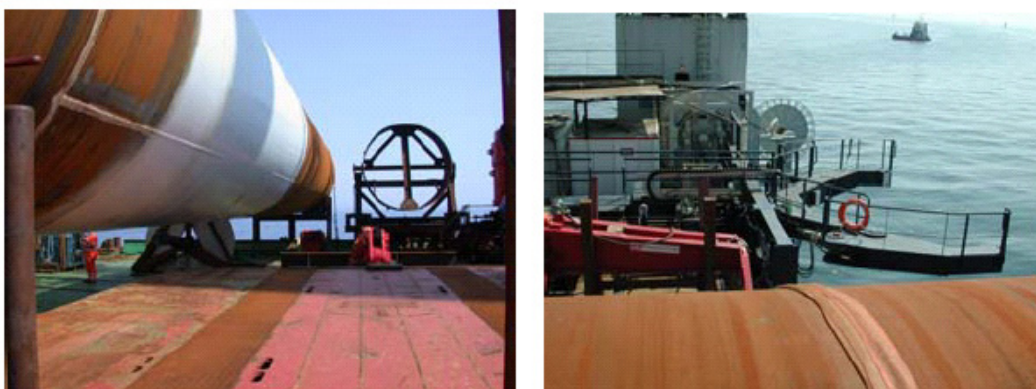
Dima di inclinazione e posizionamento installate sul pontone.
